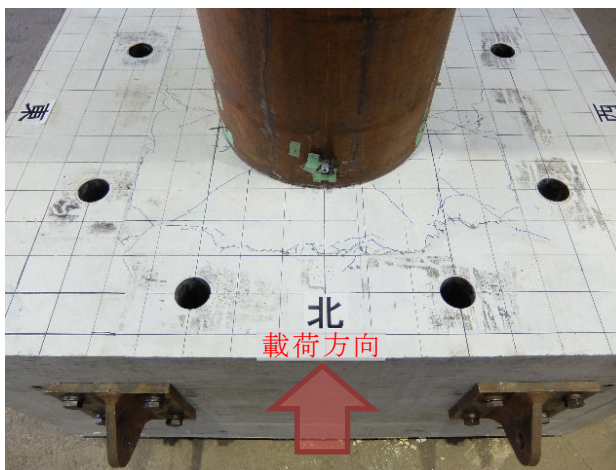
フーチング上面のひび割れ状況（ケース④）
